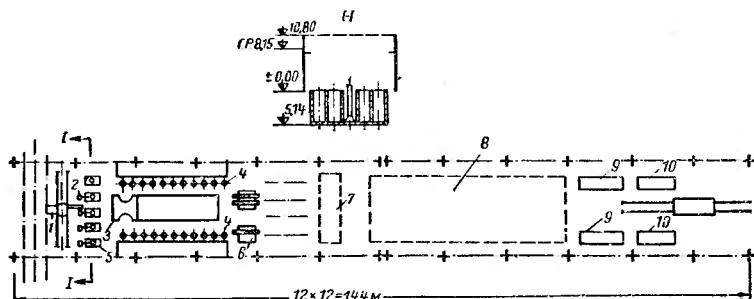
Габаритная схема технологической планировки УТП-1 производства железобетонных труб (без арматурного отделения) методом гидропрессования (04-09-5)
